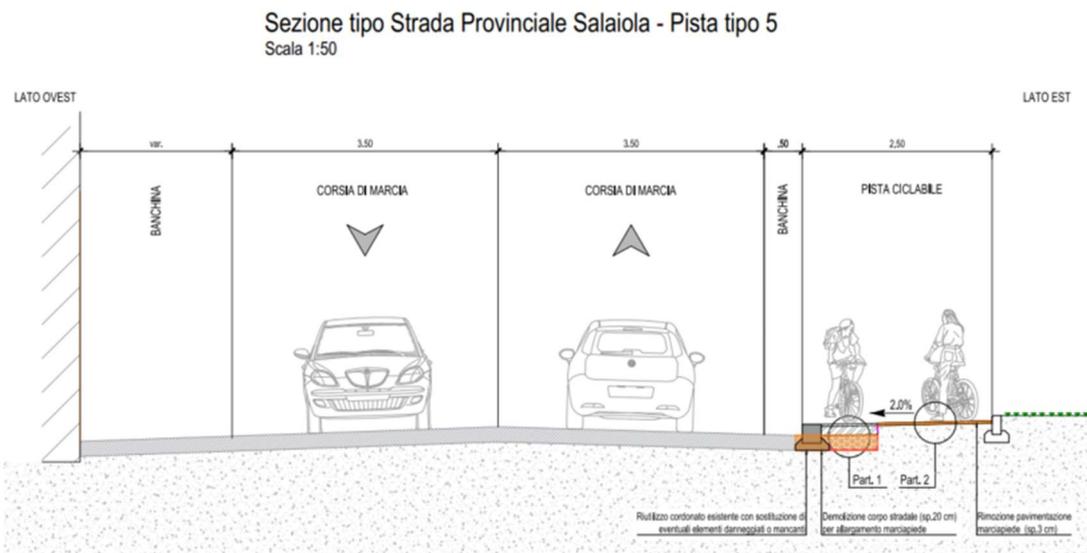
Sezione tipo Strada Provinciale Salaiola – primo tratto
